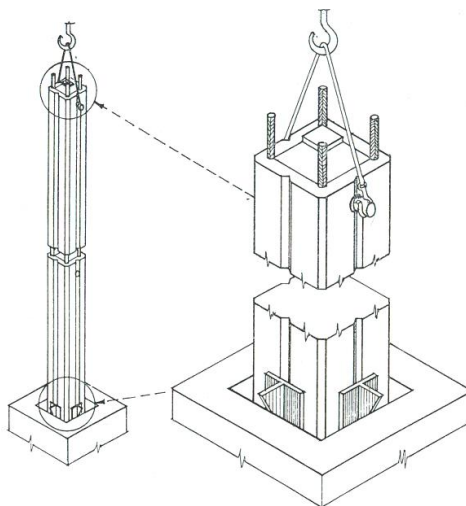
Схема монтажу і кріплення колон першого ярусу до фундаментів.
